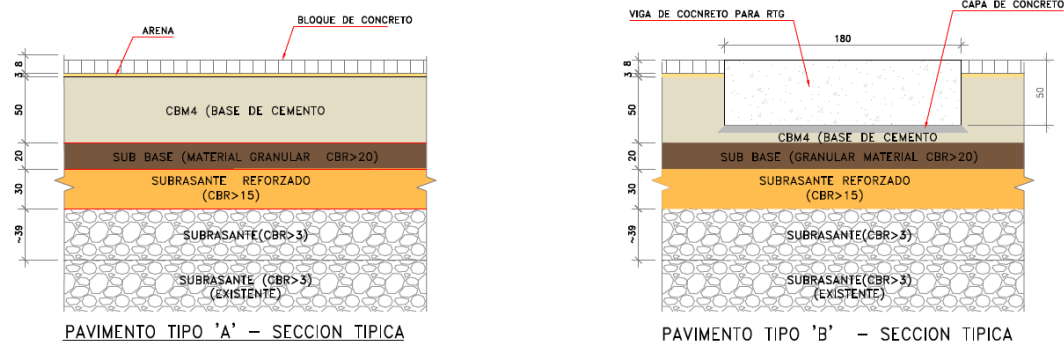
4. Secciones típicas de pavimento en el patio de contenedores
